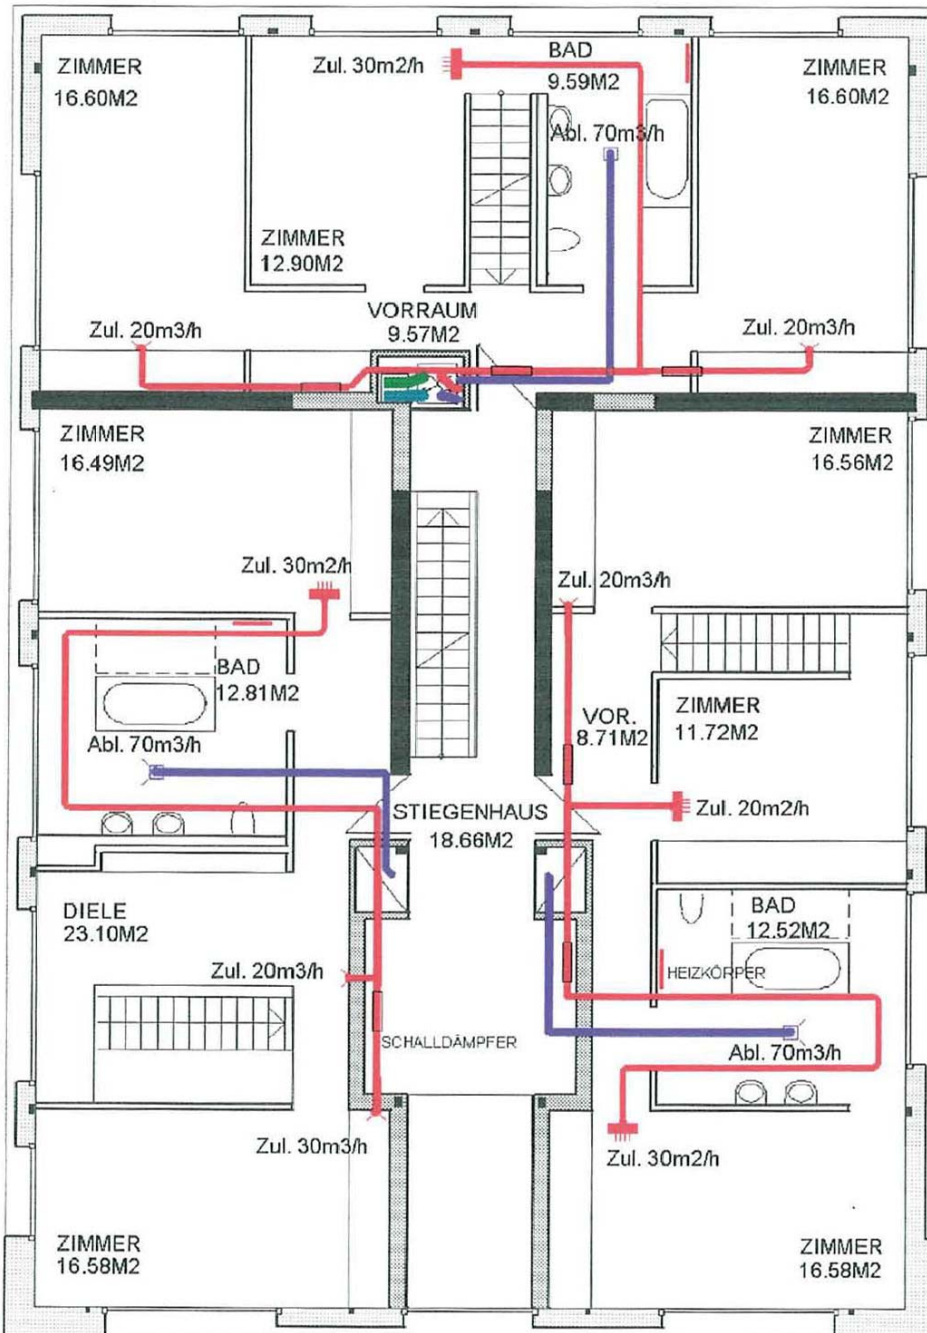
Haustechnik Grundriss, Projekt "Wolfurt"
